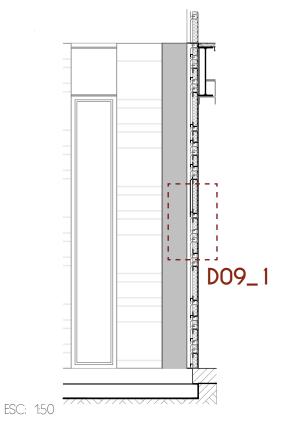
Detalle constructivo 09.. (Autoras, 2019)
